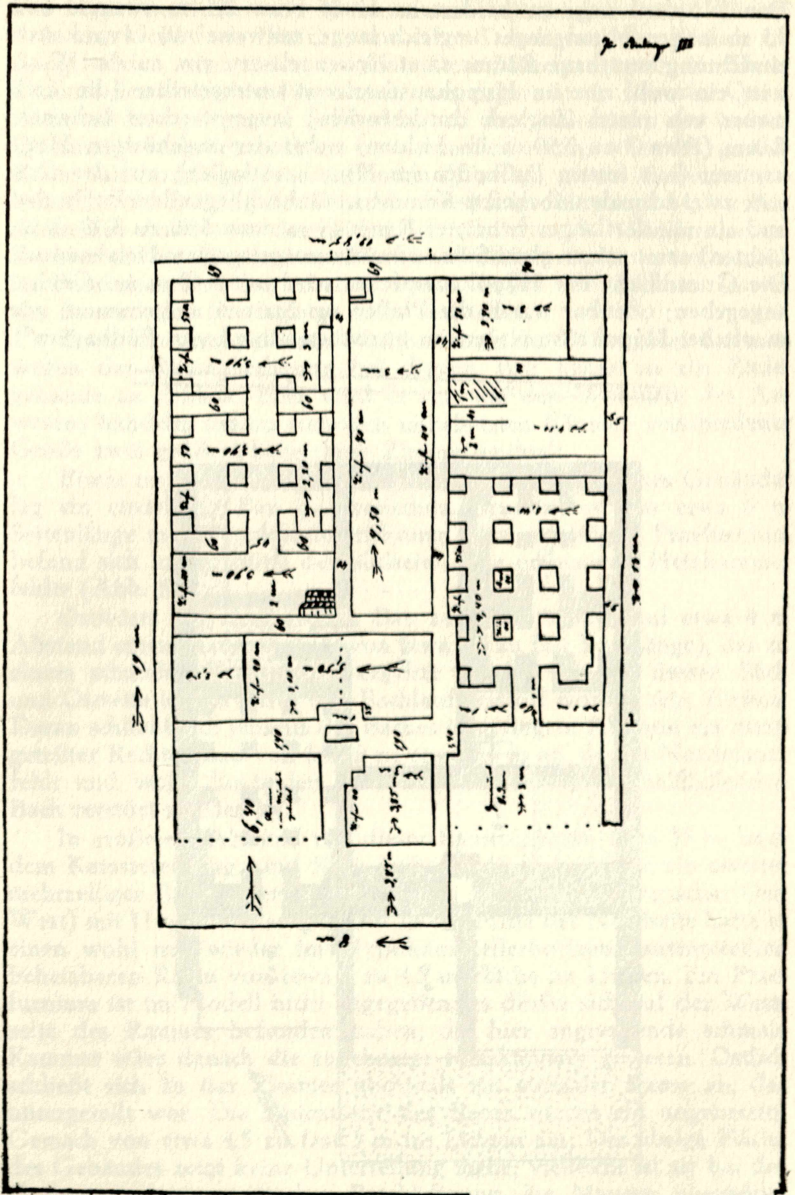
Karlstein. Gebäude I. Plan nach der Ergänzungsgrabung von J. Maurer mit Maßangaben. M etwa 1:200.
